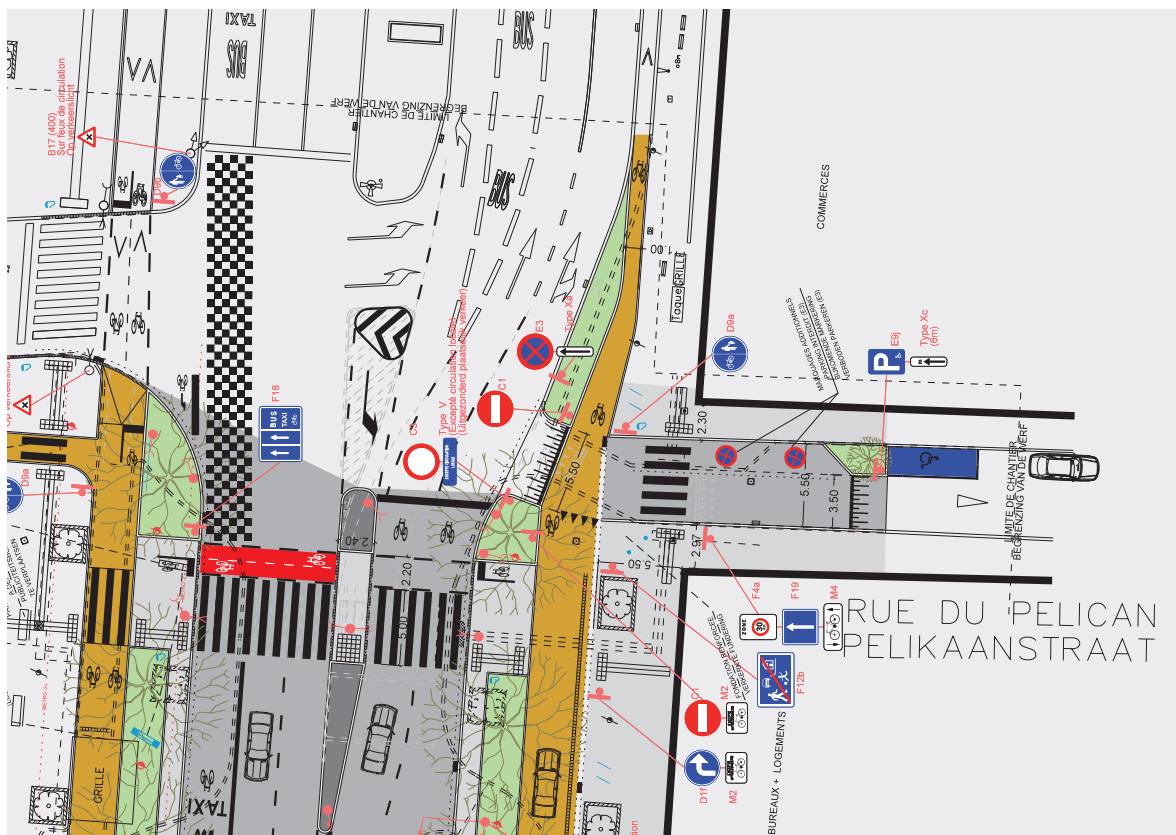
Boulevard Baudouin, à hauteur de la Rue du Pélican – Transition d'une piste cyclable bidirectionnelle à une piste cyclable unidirectionnelle.
